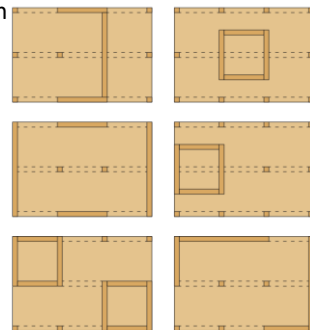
Eksempel på lang bygning, hvor 3 afstivende vægge ikke er tilstrækkeligt til at stabilisere konstruktionen.
